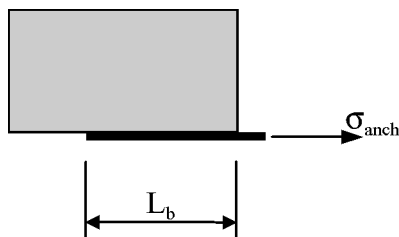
Ensayo de adherencia de un laminado de material compuesto sobre una viga de hormigón.
